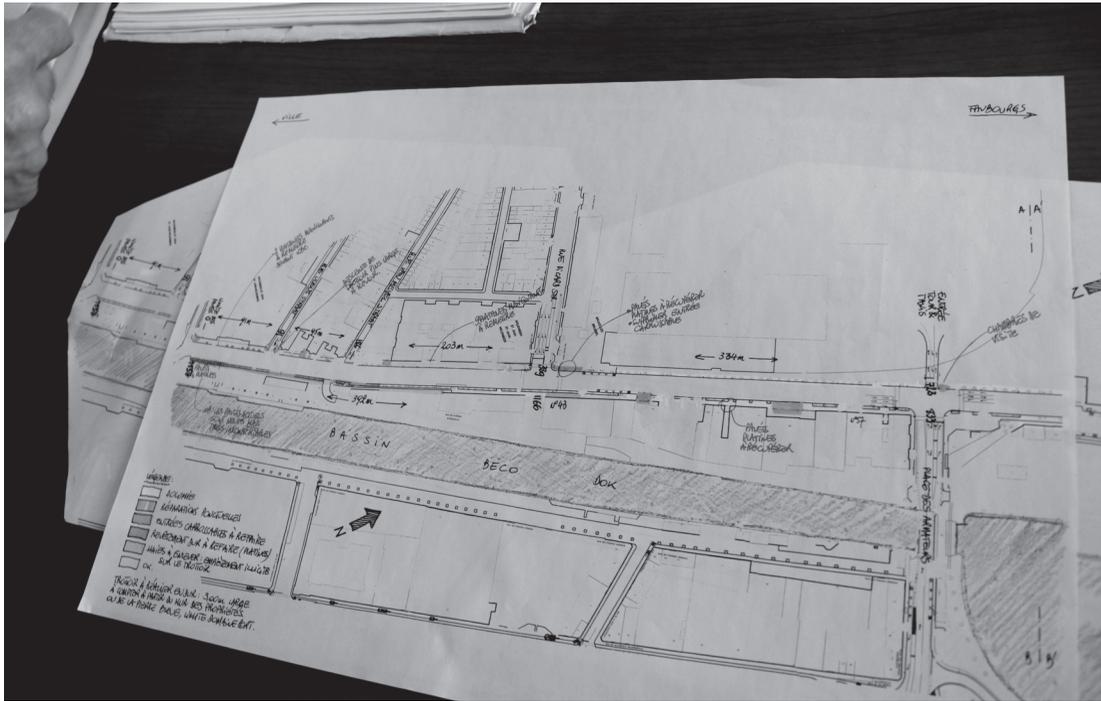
PLAN DÉTAILLANT LES REVENDICATIONS CONCERNANT L'AVENUE DU PORT. © PATRICK WALTERS, PHOTO : GIULIETTA LAKI.
